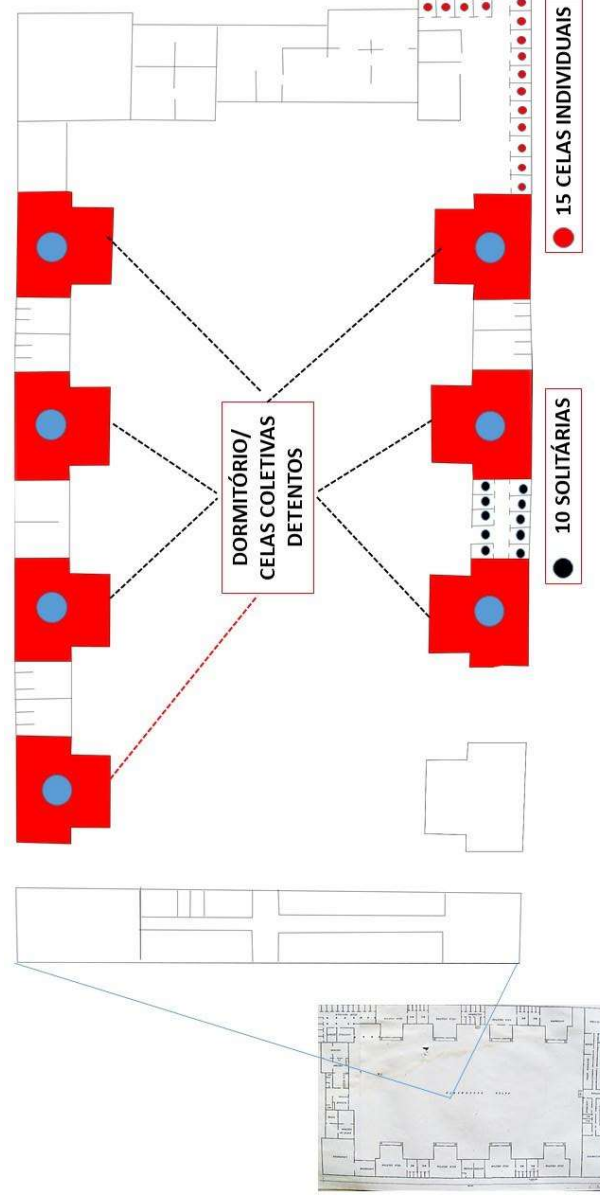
Planta baixa da Colônia correcional da Ilha Anchieta (1930-1940)
